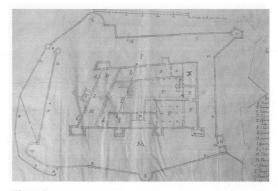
Plano de la planta general del castillo y muralla exterior hacia 1720 (Aguas s.a, 2)
